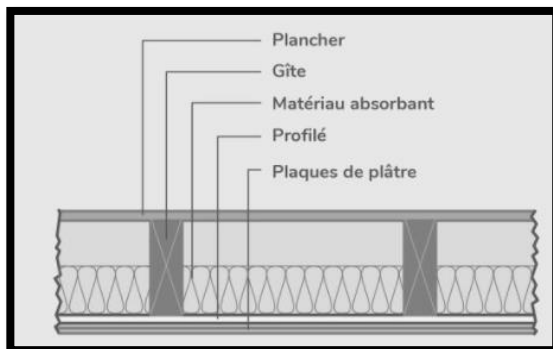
coupe transversale de faux plafond avec isolant acoustique.
